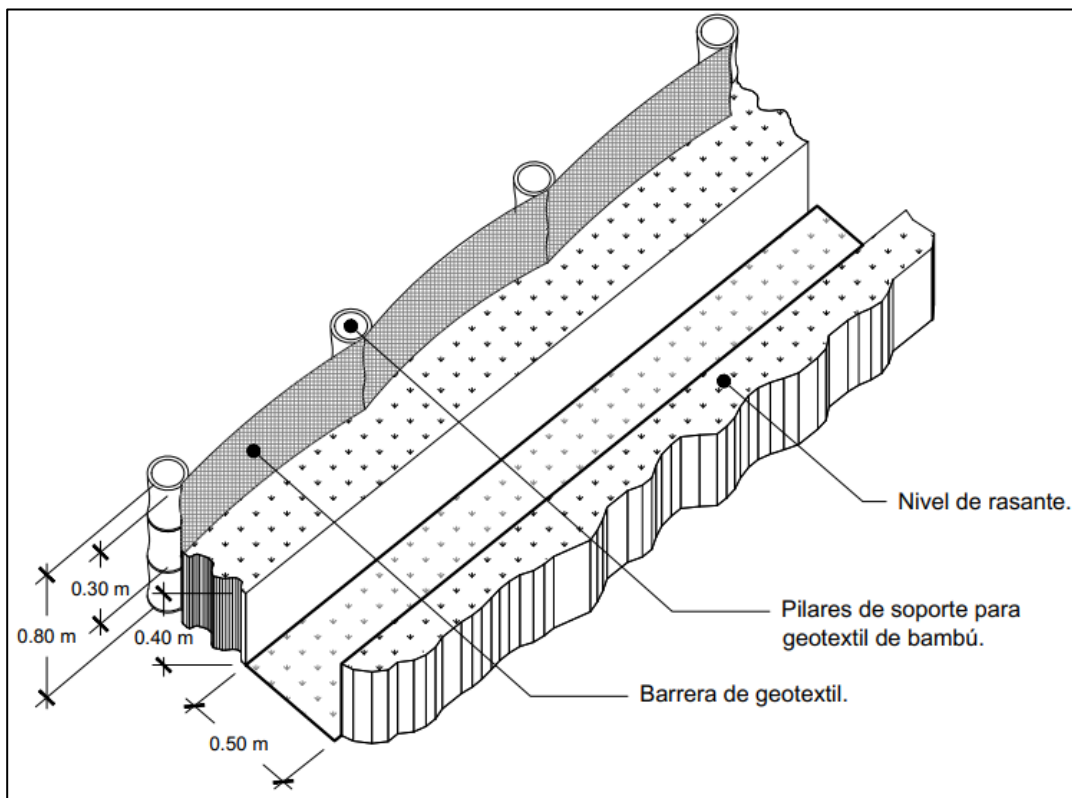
Barrera de geotextil y tramo de canaleta 1. [Elaboración propia]
